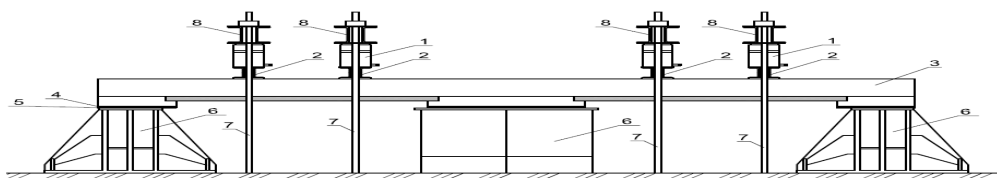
Стенд для випробування залізобетонних плит незнімної опалубки:
